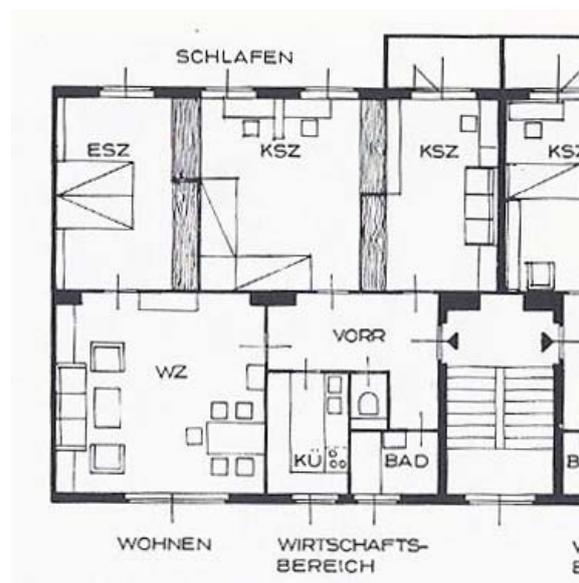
Wohnhausanlage Mauerbachstraße, Saalwohnung, Variante 2
